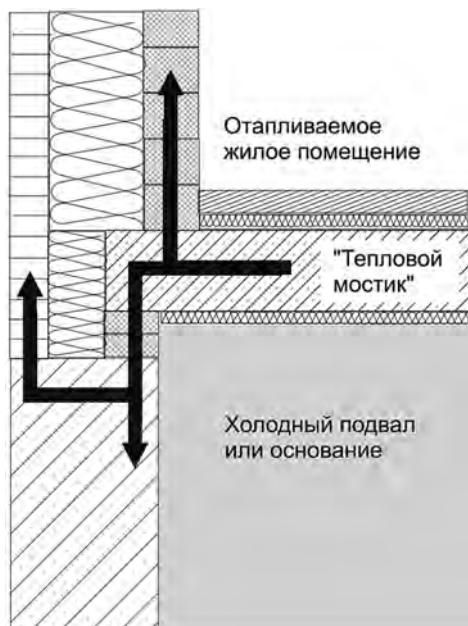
«Тепловой мостик» в месте стыка половой наружной стены с стены с подвальным перекрытием и подвальной стеной (или с плитой основания и фундаментной стеной)
